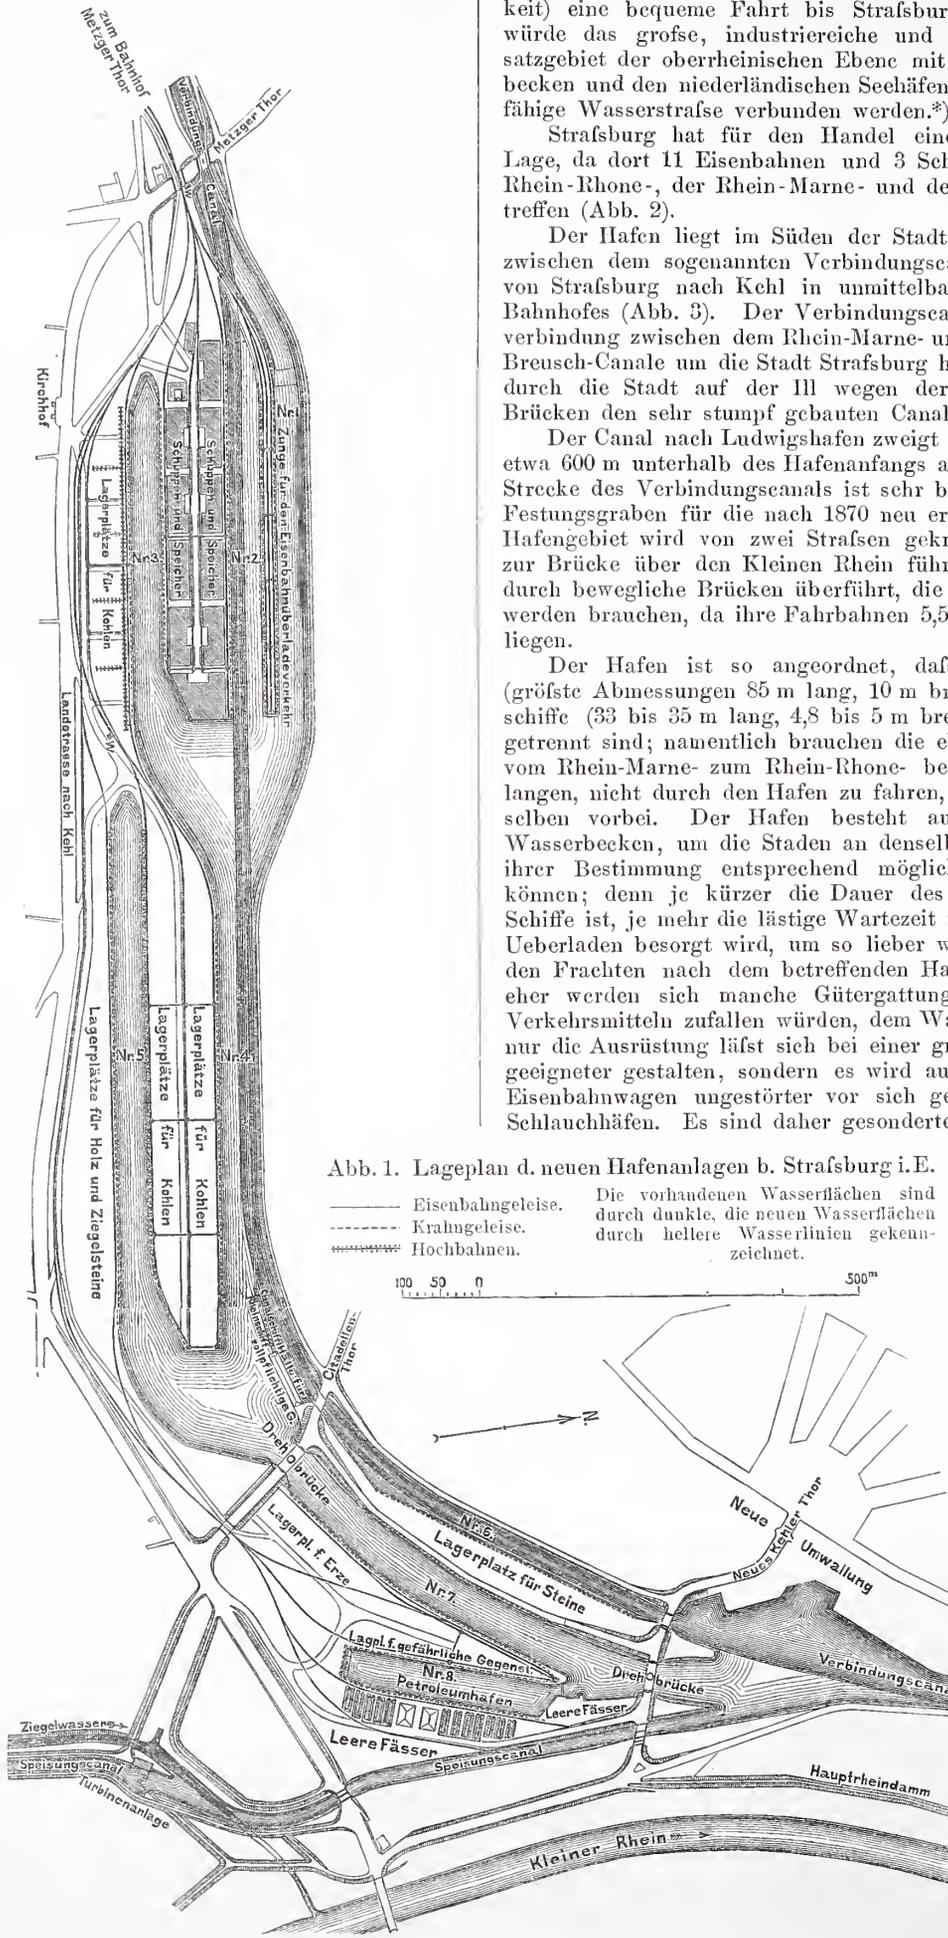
Lageplan d. neuen Hafenanlagen b. Straßburg i. E.
